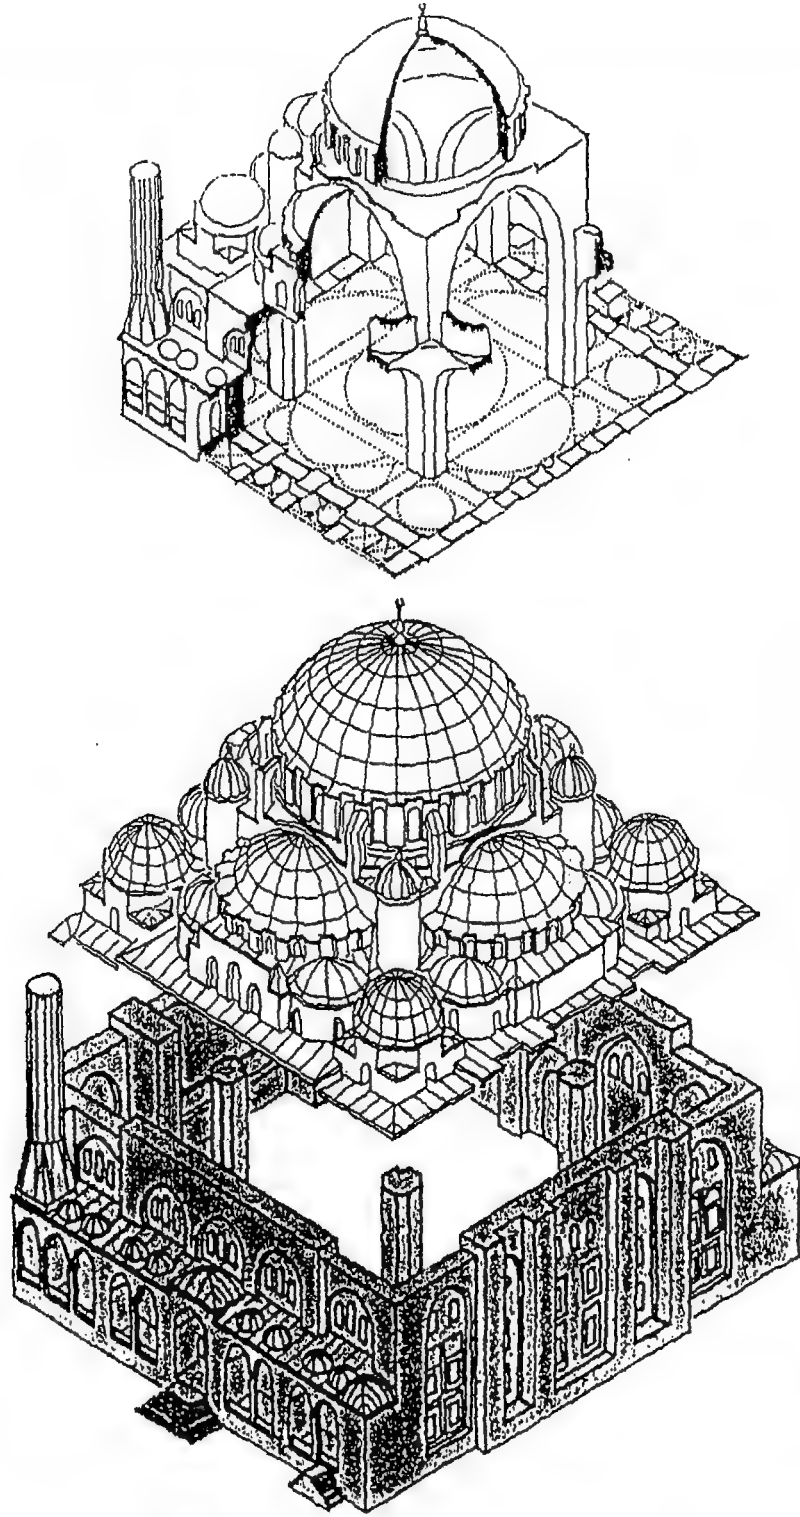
مسقط أفقى لمجمع شهزاده محمد بإستانبول.
